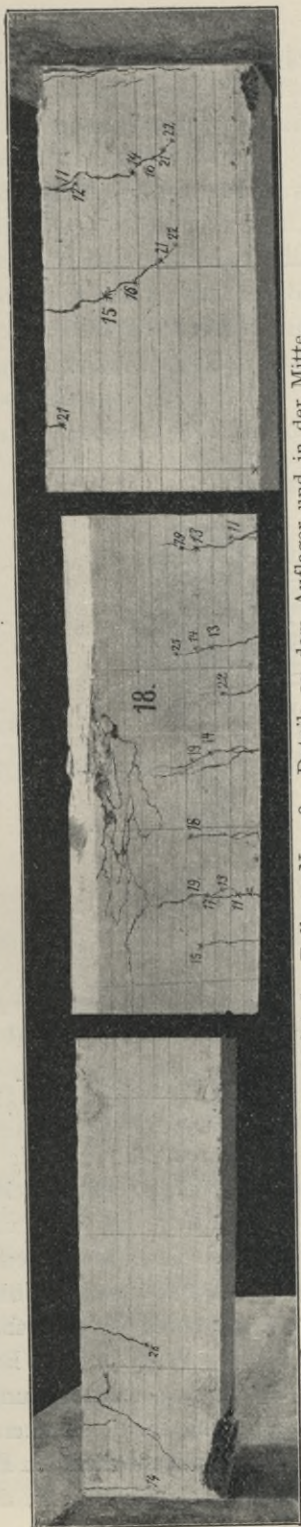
Bruchbild des Balkens Nr. 18. Details an dem Auflager und in der Mitte.
